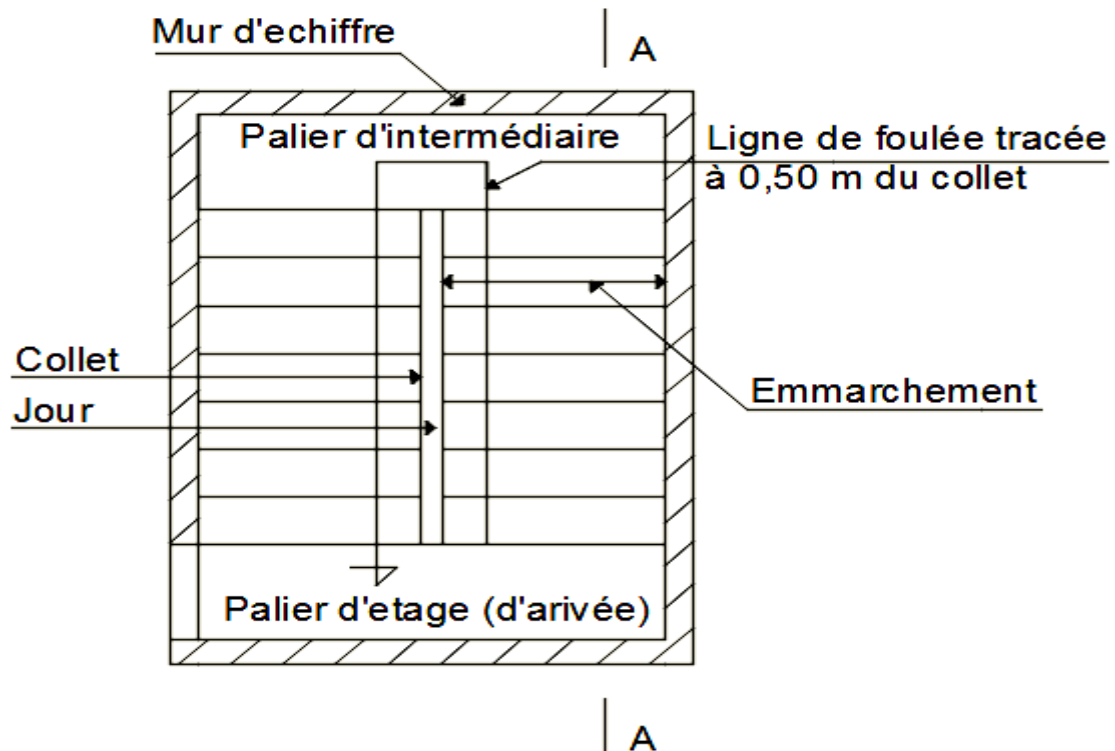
N°01 : Vue en plan de la cage d'escaliers.
